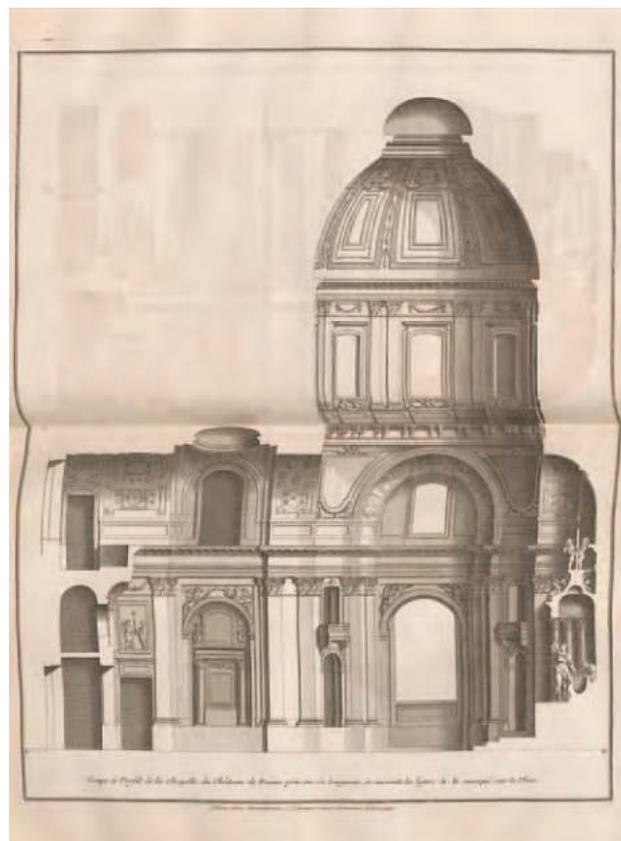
J. F. Blondel, Coupe et Profil de la Chapelle du Château de Fresne pris sur sa longueur (da BLONDEL 1738).
